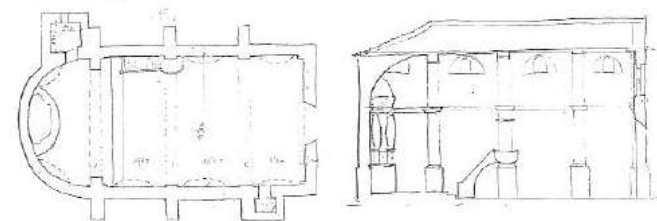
Planta y sección de la Ermita de la Mare de Déu de Gràcia.
